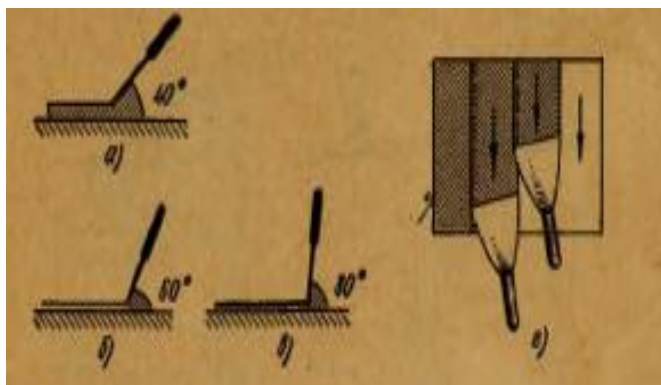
Прийоми нанесення шпатлівки на поверхню залежною від товщини шпатлювального шару: а – положення шпателя під кутом 40°, б – положення шпателя під кутом 60°, в – положення шпателя під кутом 80° («на здір»), з – прийоми з'єднання смуг шпатлівки
